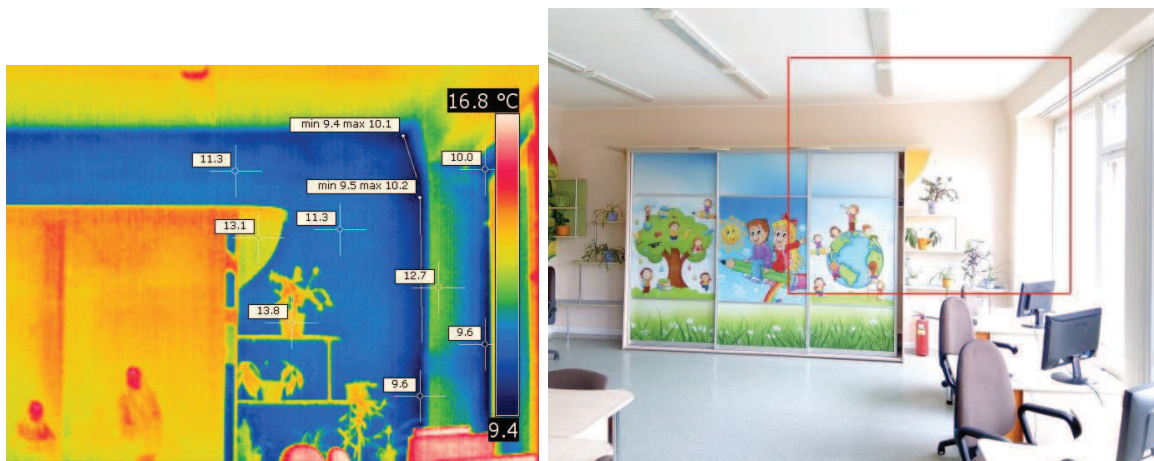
Стена помещения №312 (компьютерный класс), западный фасад
